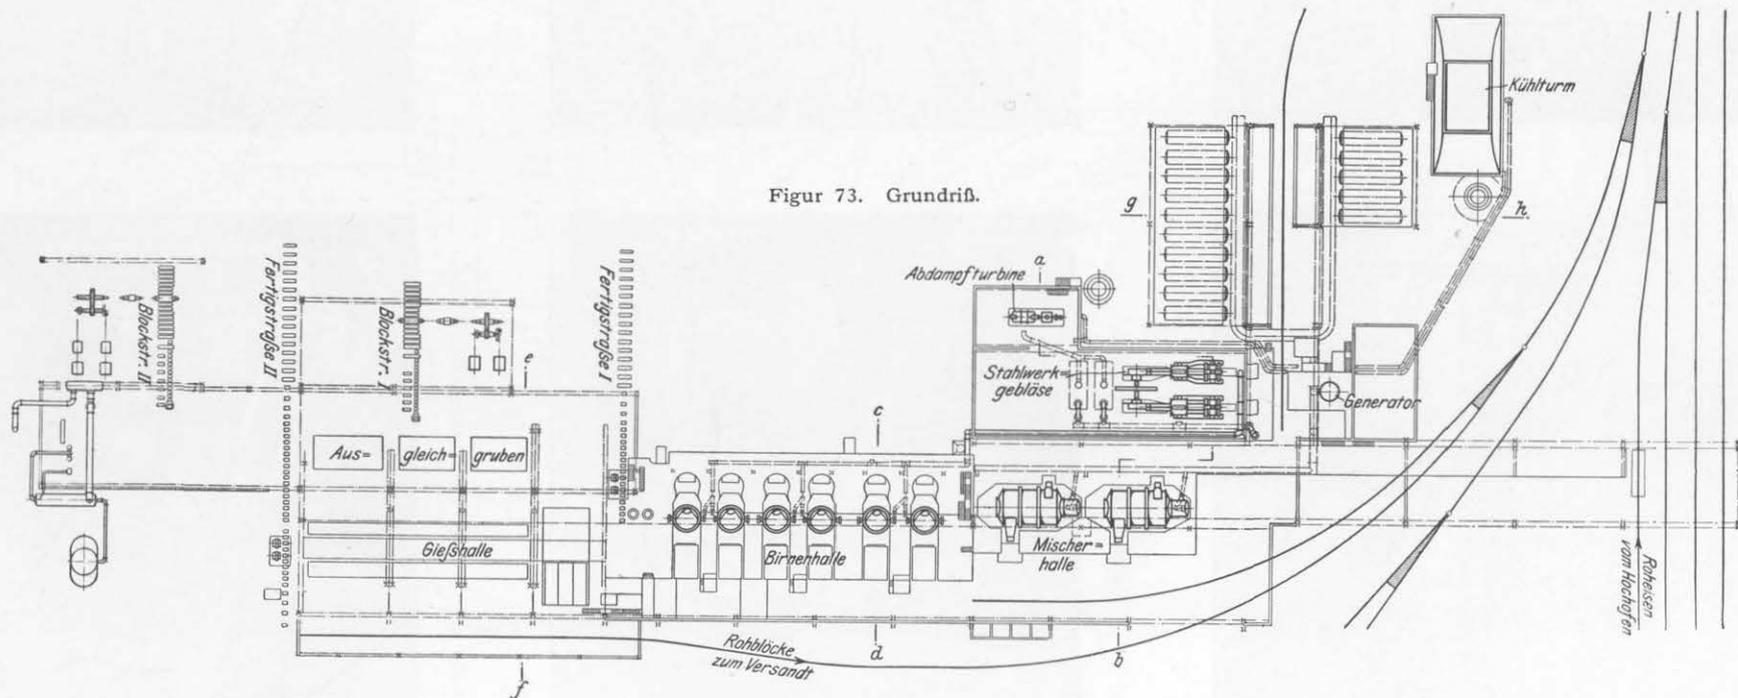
und 73. Thomas-Stahlwerk mit den zugehörigen Betrieben.
